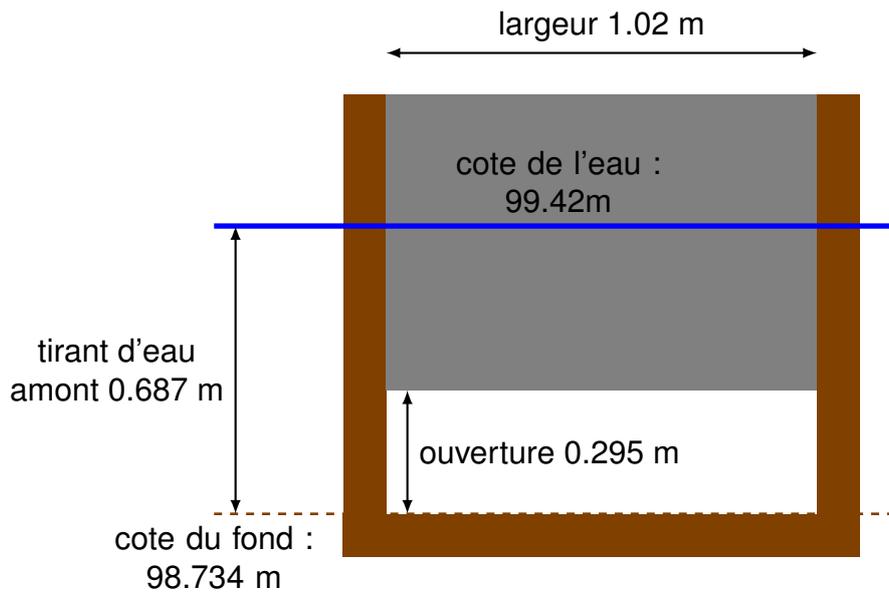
Coupe transversale de la vanne de la prise d'eau du canal du Prat Pialoux
